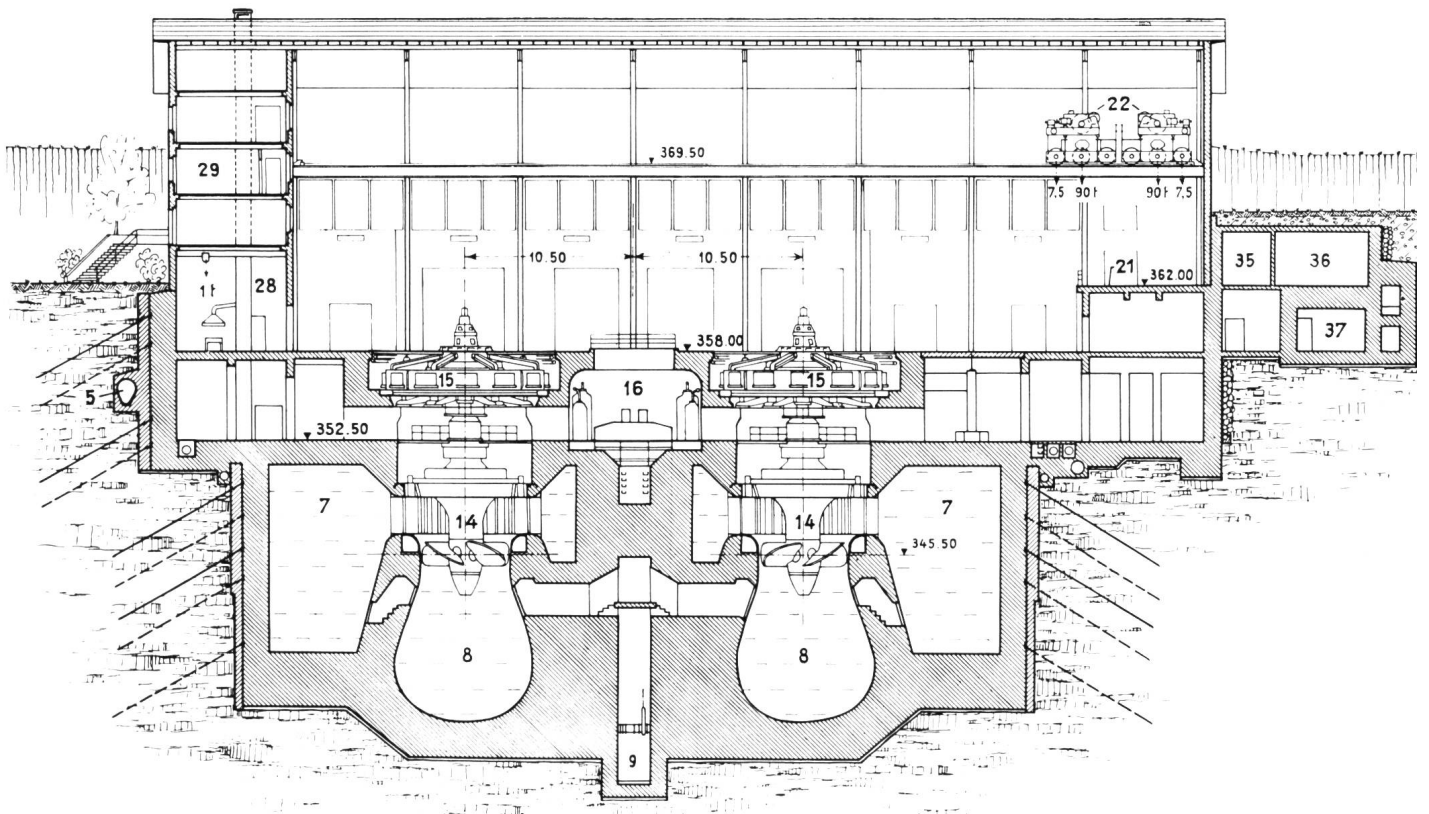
Längsschnitt 1 : 500 durch Maschinenhaus
